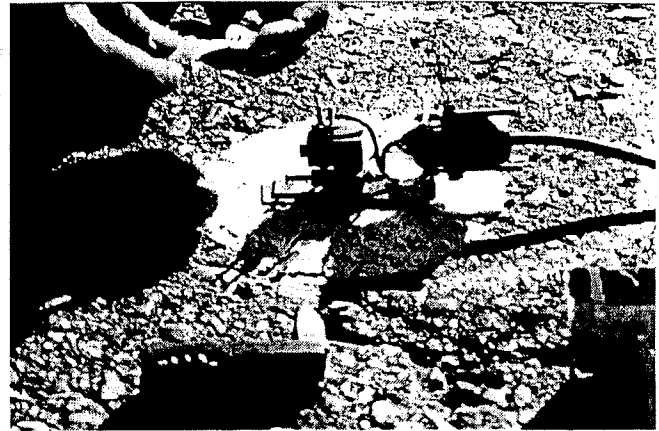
Crack Activity Meter (CAM) colado ao pavimento
